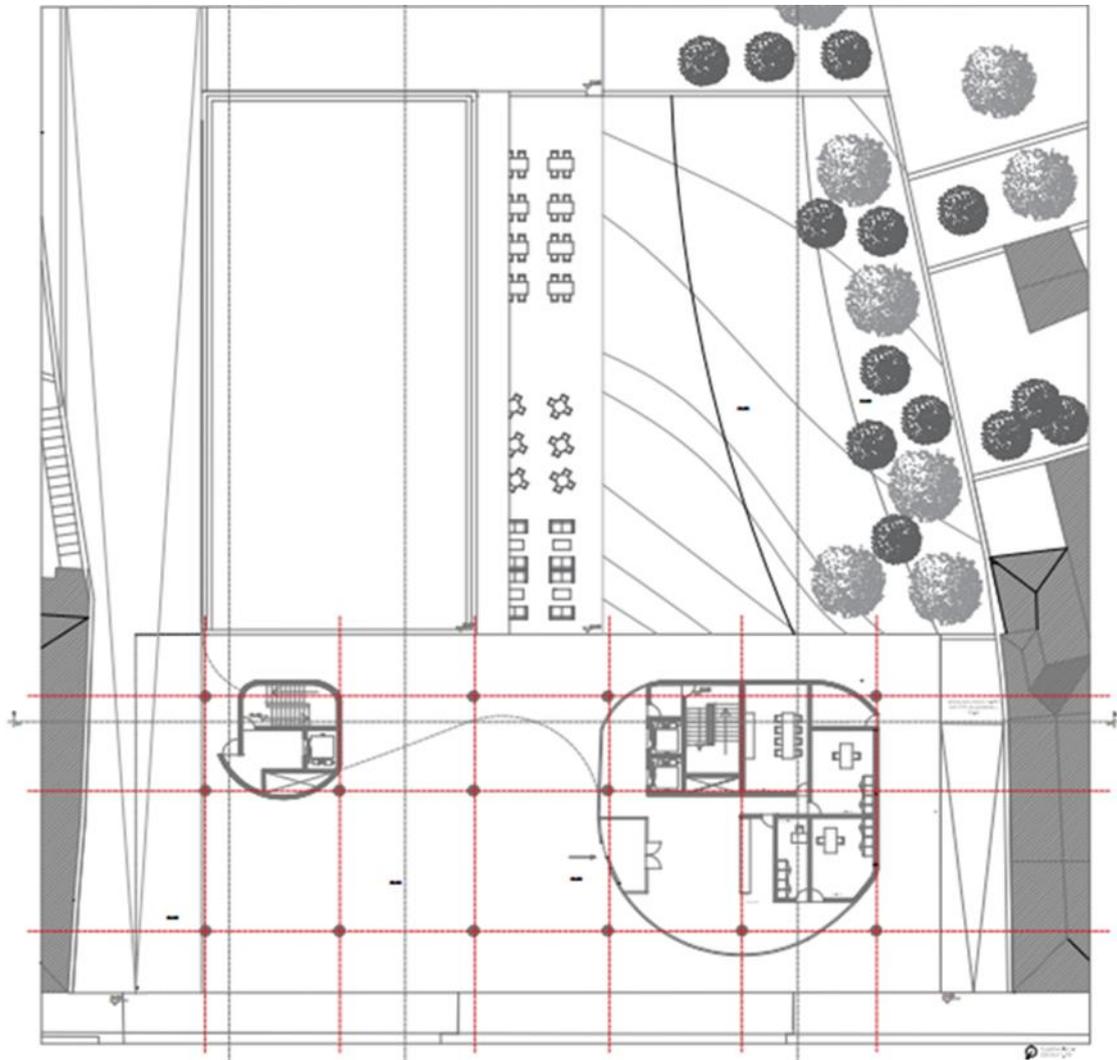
Planta piso 0 Final sem escala, (Fonte: Autor, 2015)
